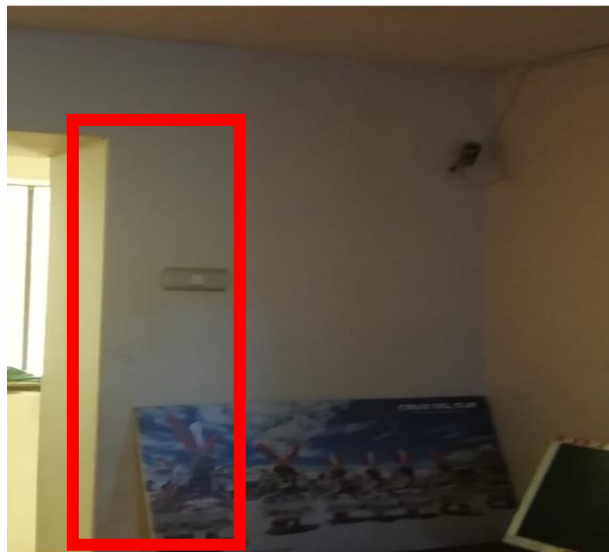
Foto de una de las columnas donde se va aplicar el reforzamiento.
